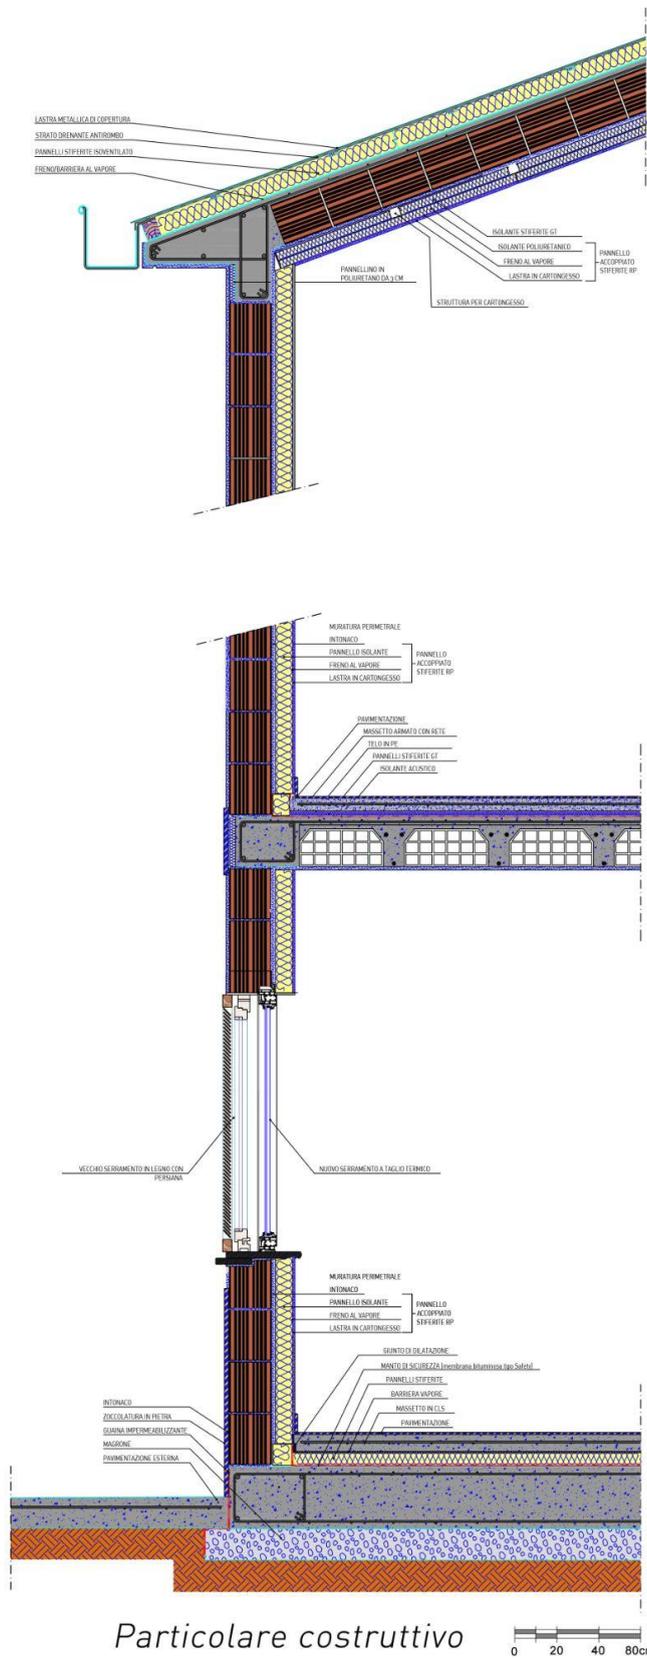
Particolare costruttivo parete a cappotto interno e doppio infisso
